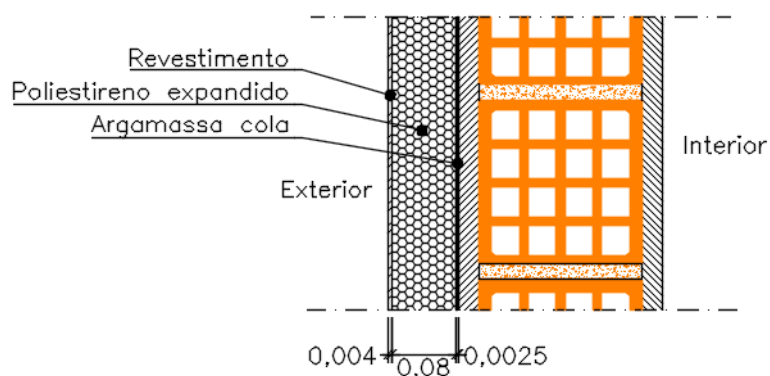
Pormenor construtivo como proposta de intervenção de parede exterior - PRE1
